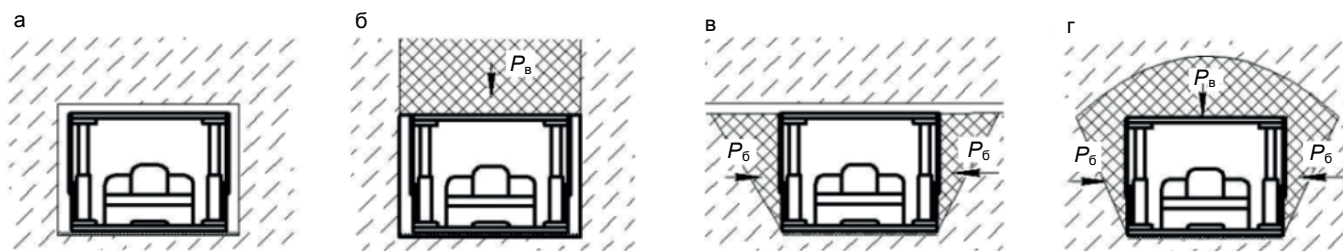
Варианты нагружения спасательного комплекса. а – отсутствие внешних нагрузок на перекрытия комплекса; б – нагружение со стороны кровли выработки; в – нагружение со стороны боков выработки; г – нагружение со стороны кровли и боков выработки.
